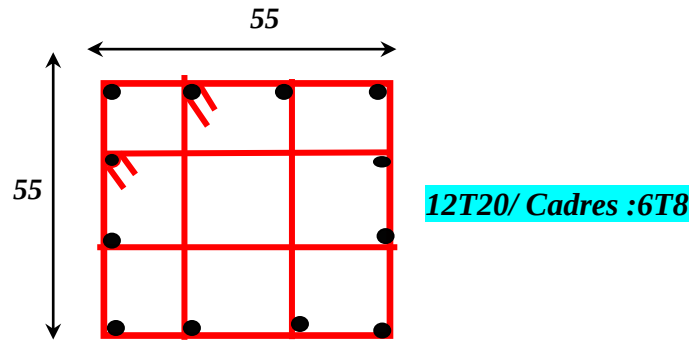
Schéma de ferrailage des poteaux 55×55.
